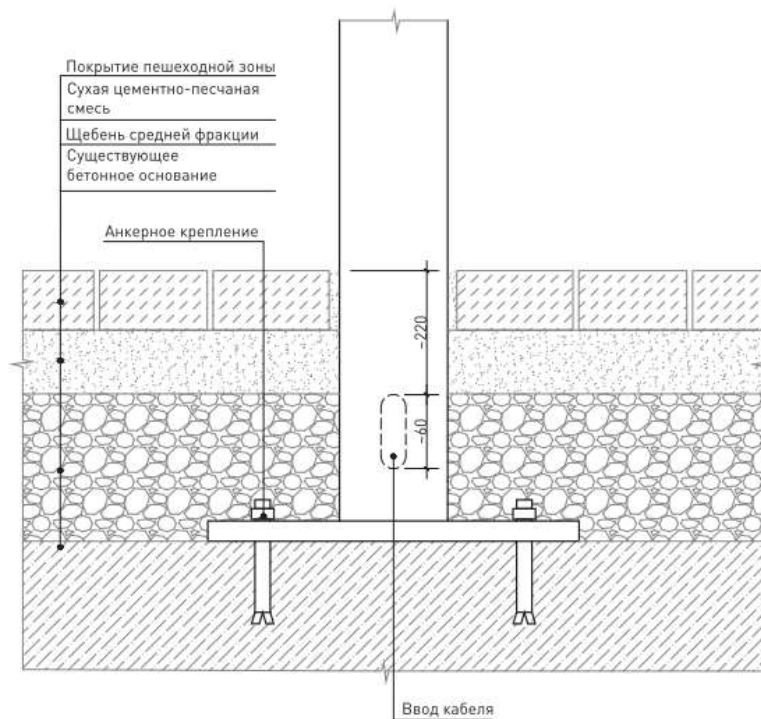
Схема установки опоры на существующий фундамент основания.
